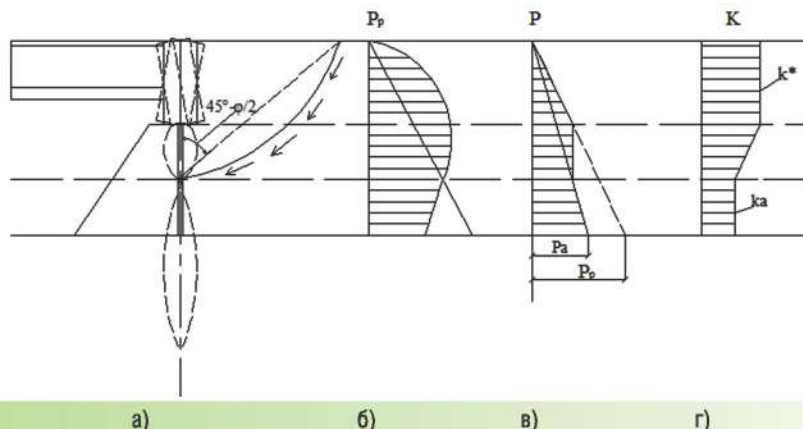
Эпюры коэффициентов давления грунта за интегральным устоем: а- деформации грунта насыпи и основания; б – эпюра пассивного давления; в- расчетная эпюра давления грунта; г – эпюра расчетных коэффициентов давления грунта
